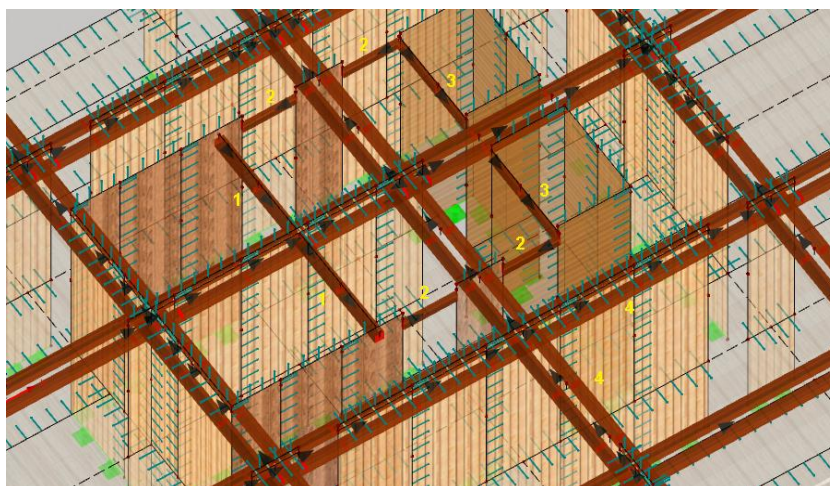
Numeração dos diferentes tipos de vigas de madeira lamelada colada existentes no sistema estrutural: (1) Vigas de suporte das escadas; (2) Vigas núcleo central; (3) Vigas caixa de elevadores e (4) Vigas duplas.
